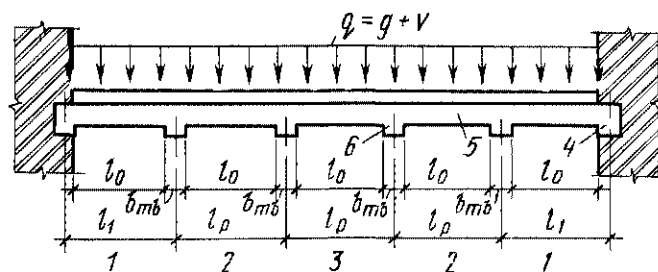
Расчетная схема неразрезной многопролетной второстепенной балки
